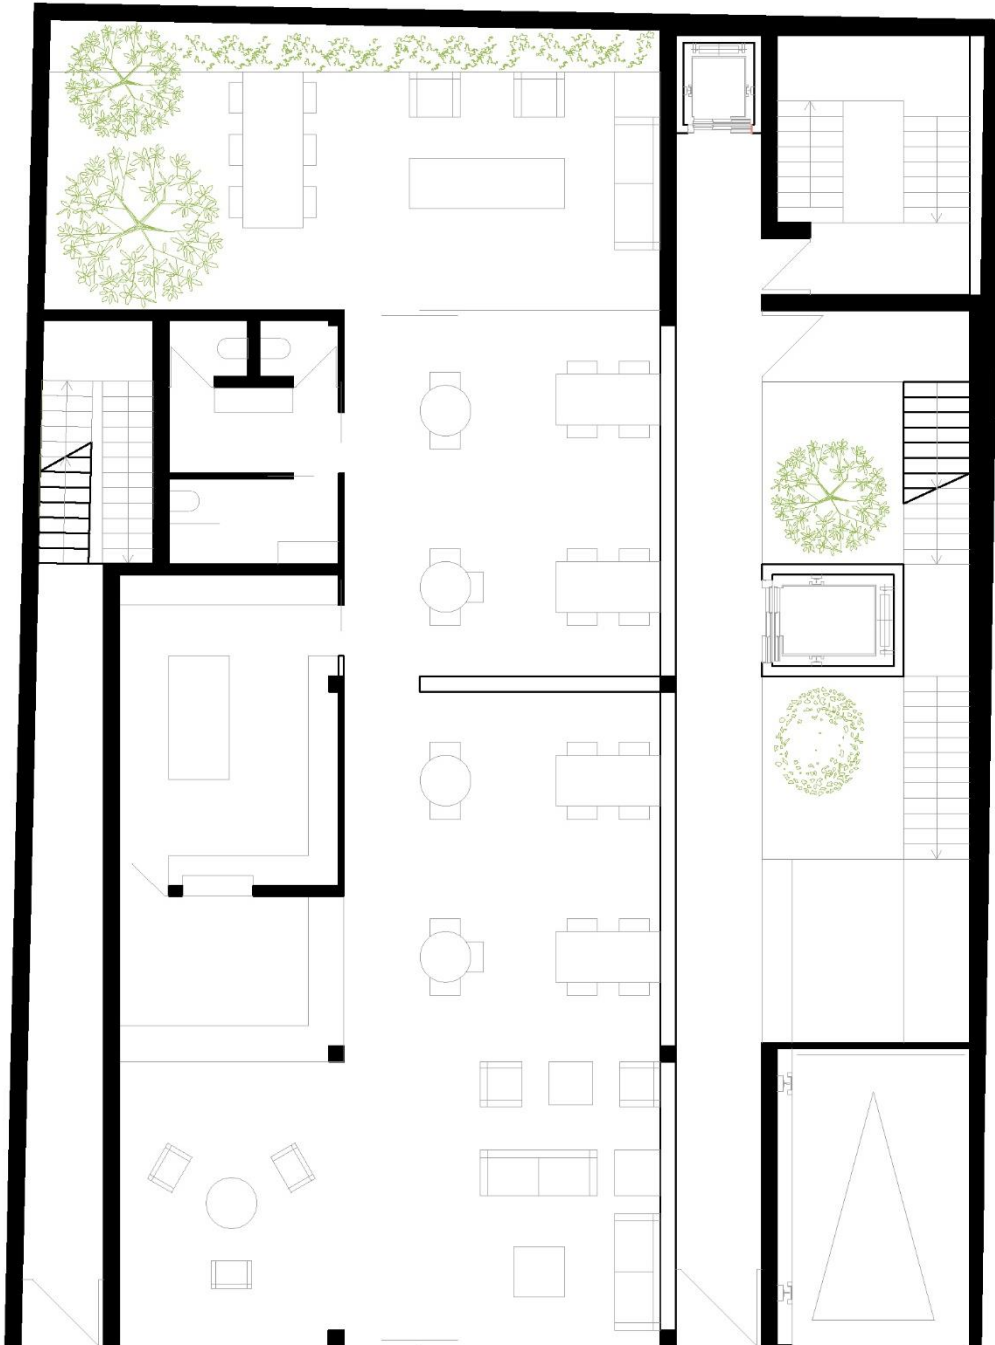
Encaje de proyecto, planta baja. Fuente: Elaboración propia.
